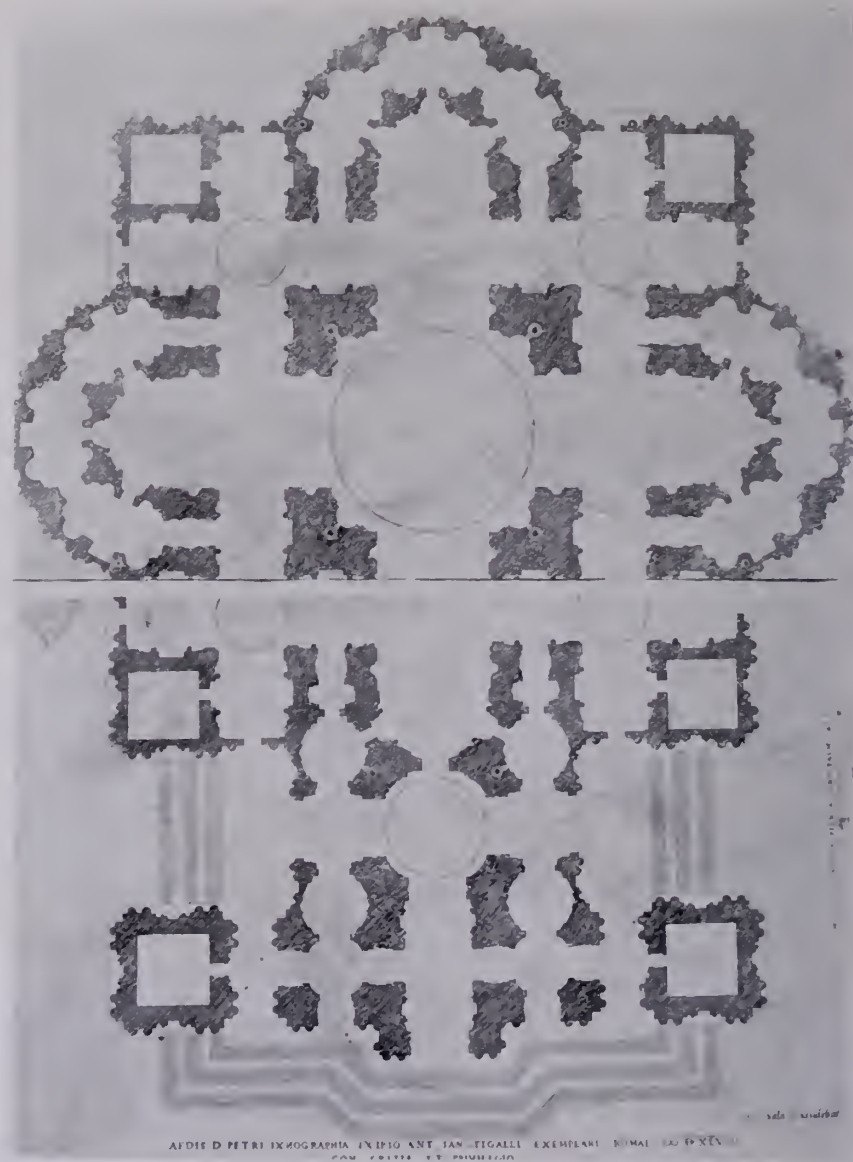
A. da Sangallo il G.: Pianta per la basilica di San Pietro.
